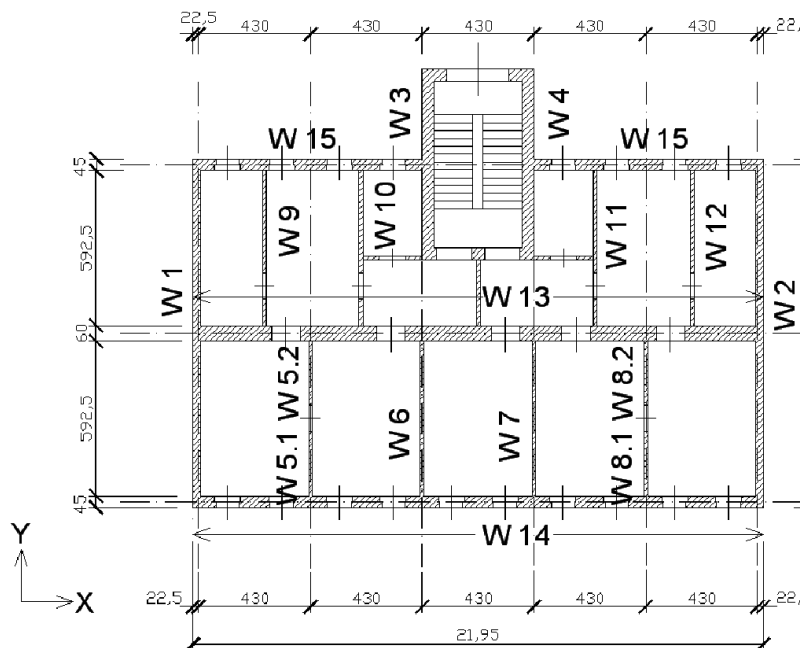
Grundriss des Mustergebäudes der Wiener Gründerzeit [Hrsg. Fachgruppe Bauwesen der LK W/Nö/Bgld; übernommen aus [6]]
